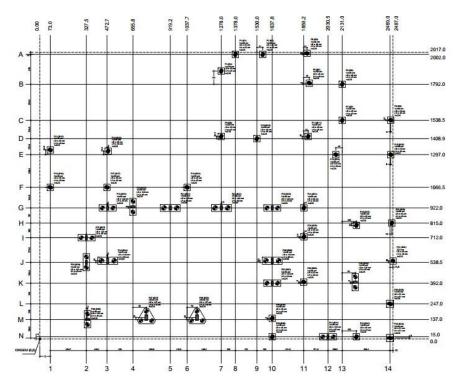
Planta de locação Fonte: Projeto Estrutural (2017)
